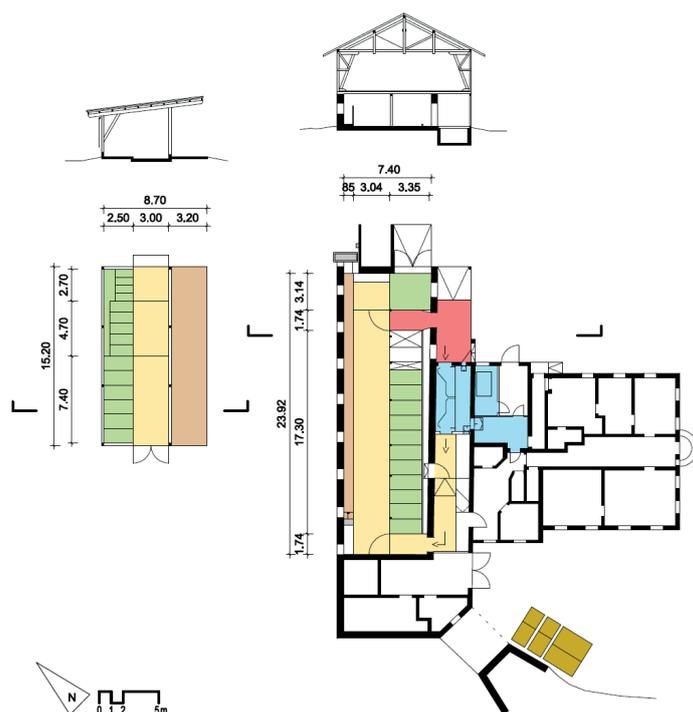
Grundrisse und Schnitte für Modell B Umbau Anbindestall in Laufstall für Milchvieh, Neubau Jungviehstall
